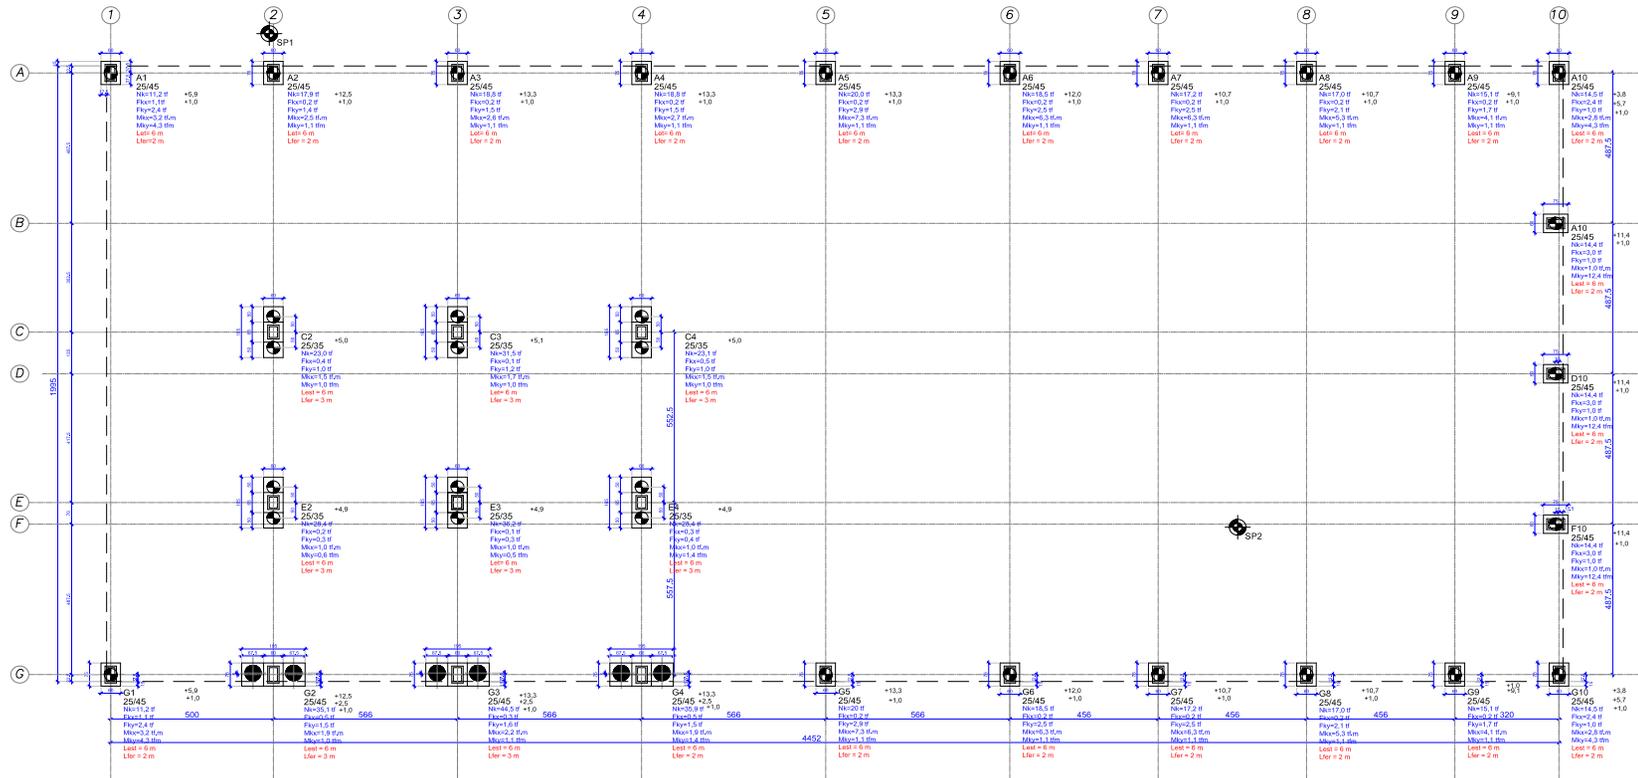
Planta de fôrmas/montagem nível pavimento superior da obra do caso B
